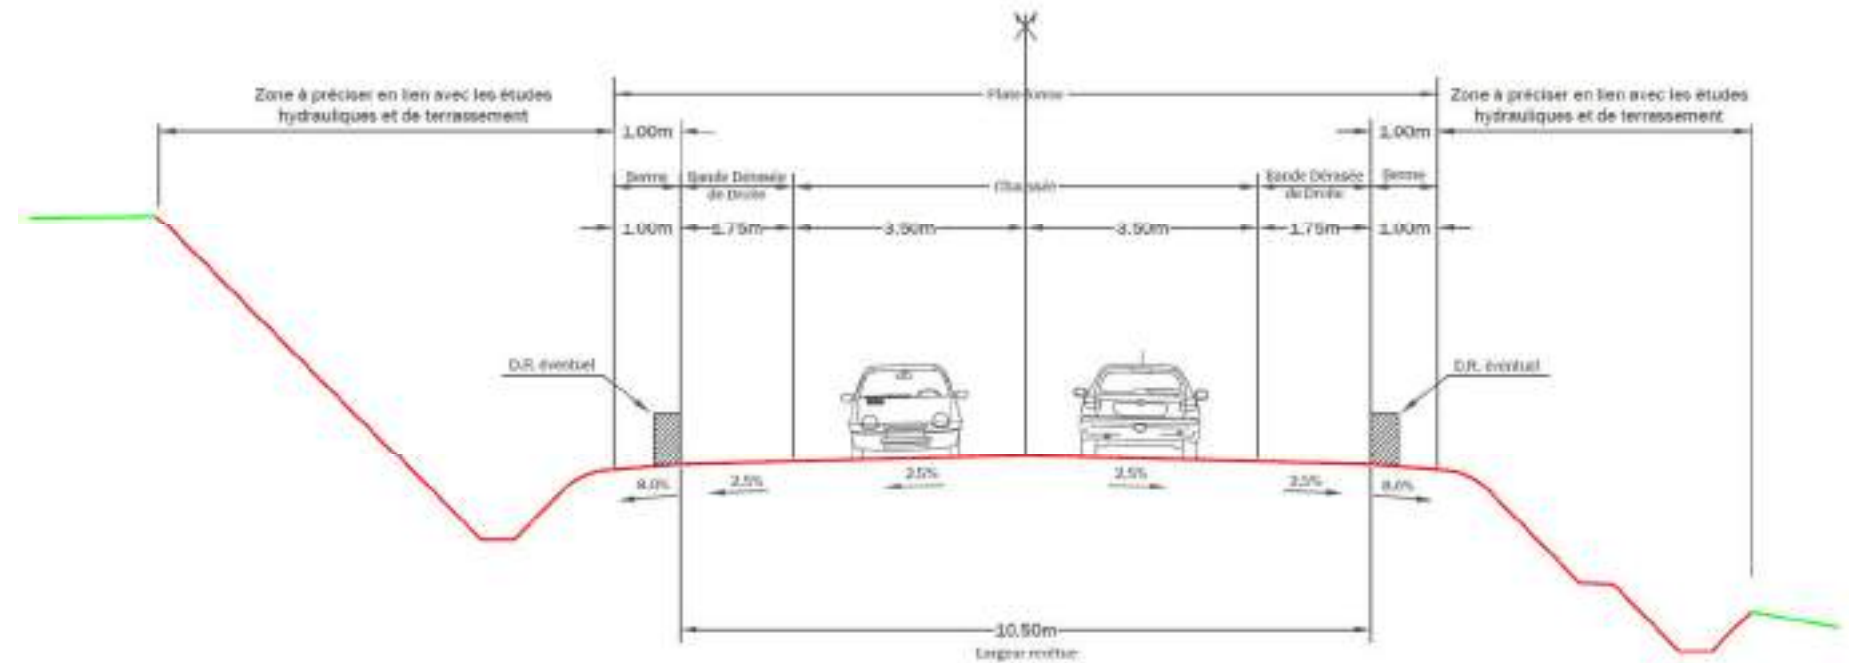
Solution proposée : profil en travers type des sections à 2 voies
